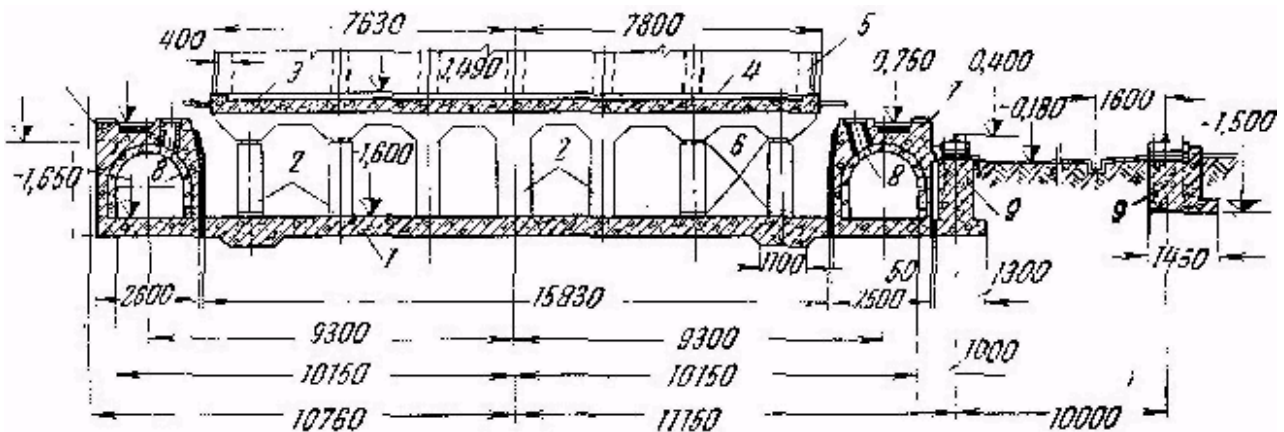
Фундамент коксовой батареи с нижним подводом отопительного газа
